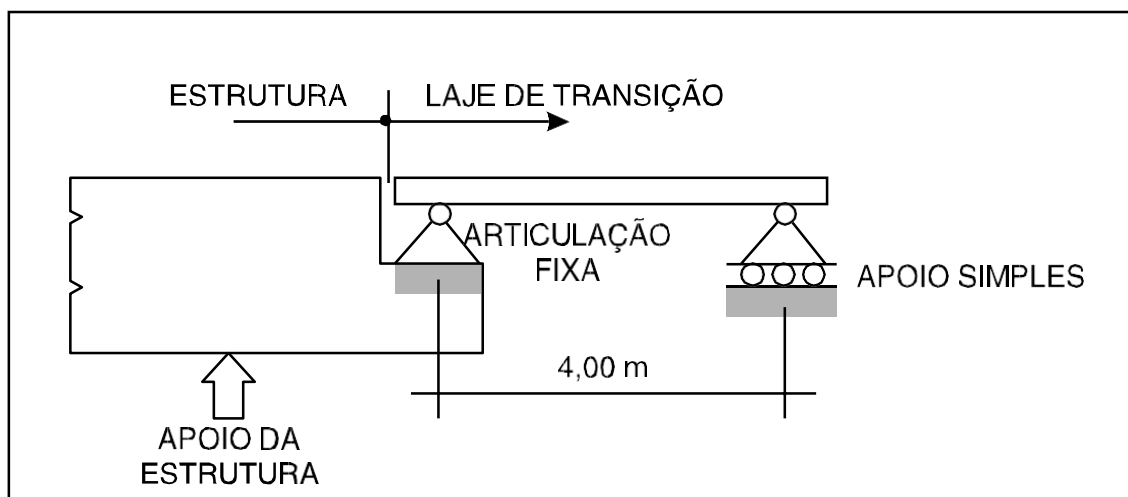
ESQUEMA ESTRUTURAL DA LAJE DE TRANSIÇÃO
